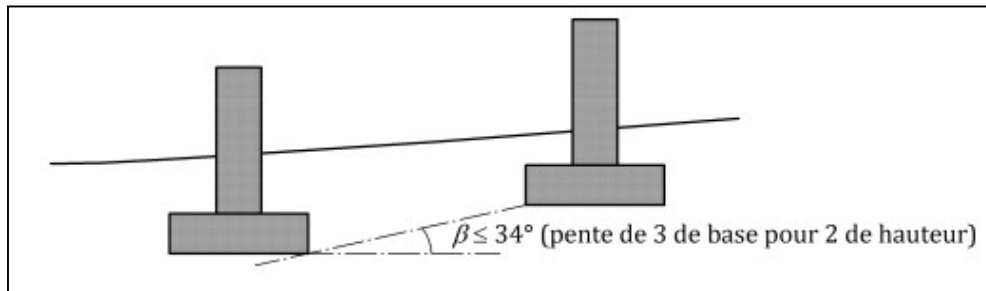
pente maximale entre fondations voisines (NF P 94-261)
